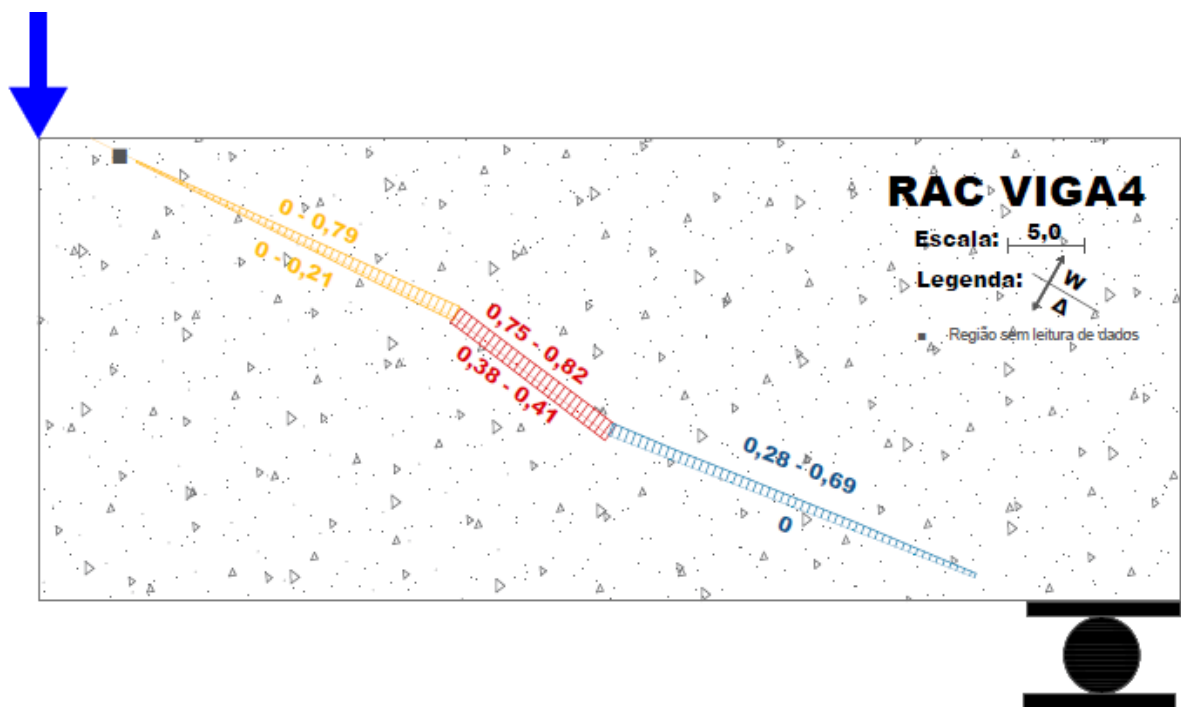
Abertura (w) e deslizamento (Δ) da fissura diagonal crítica da viga RAC-4.
